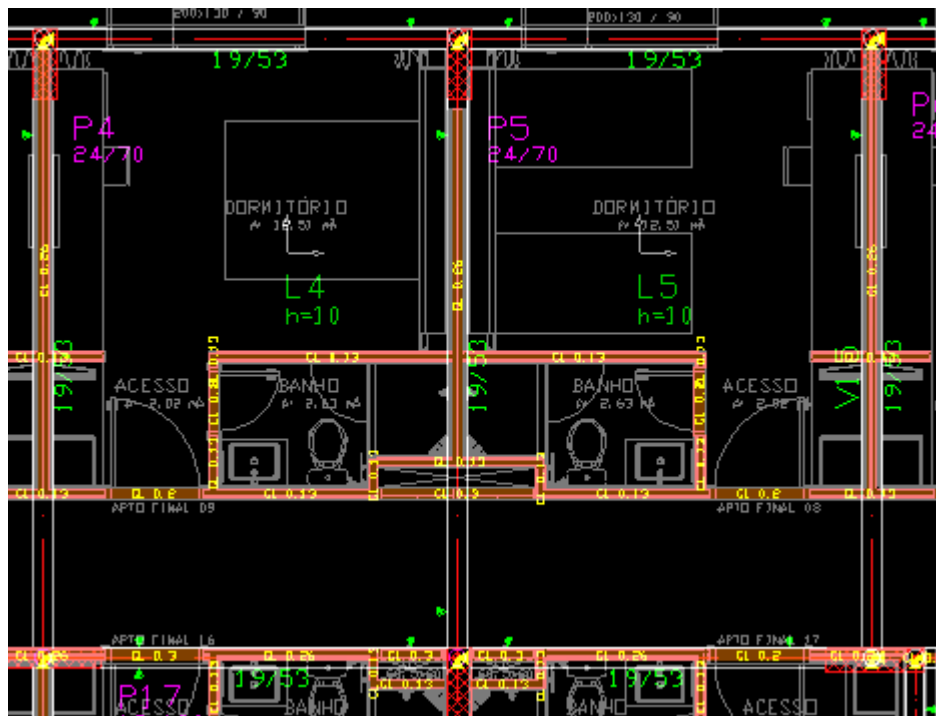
Cargas lineares lançadas no pavimento tipo. (Fonte: Autor, 2023)
